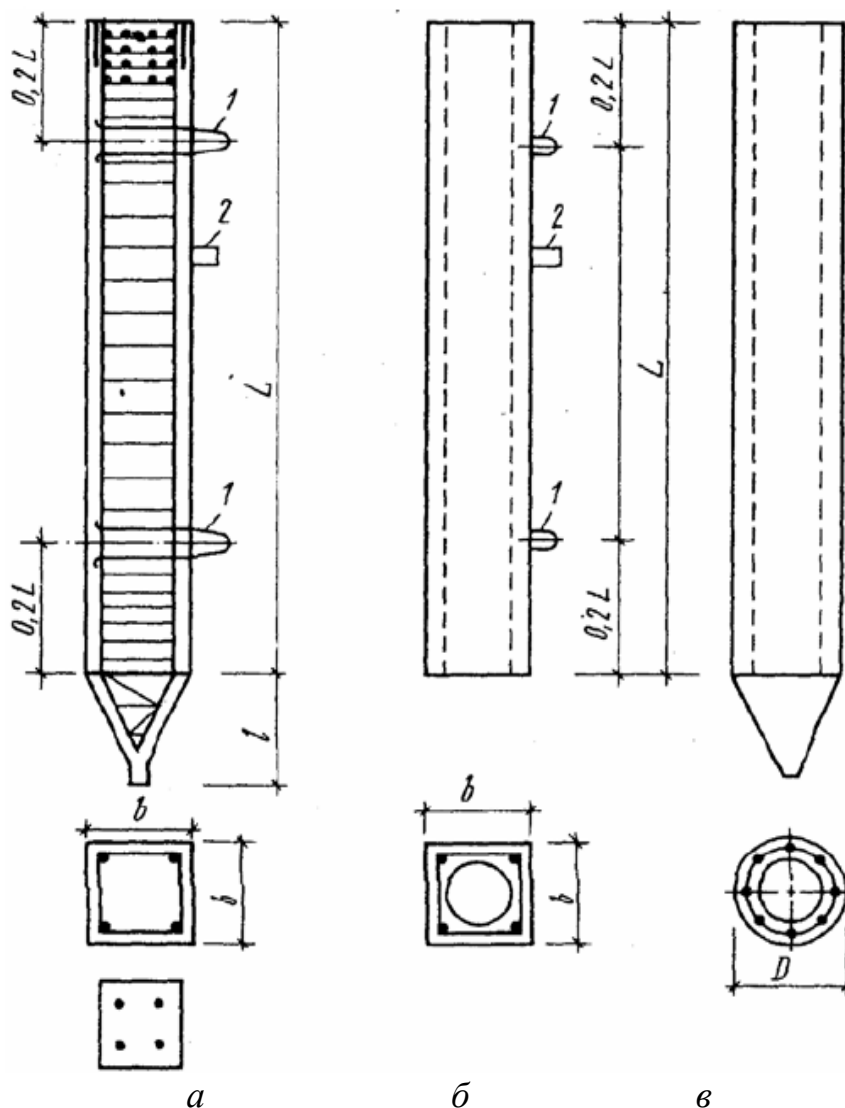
Залізобетонні палі: а – квадратного суцільного перетину;
